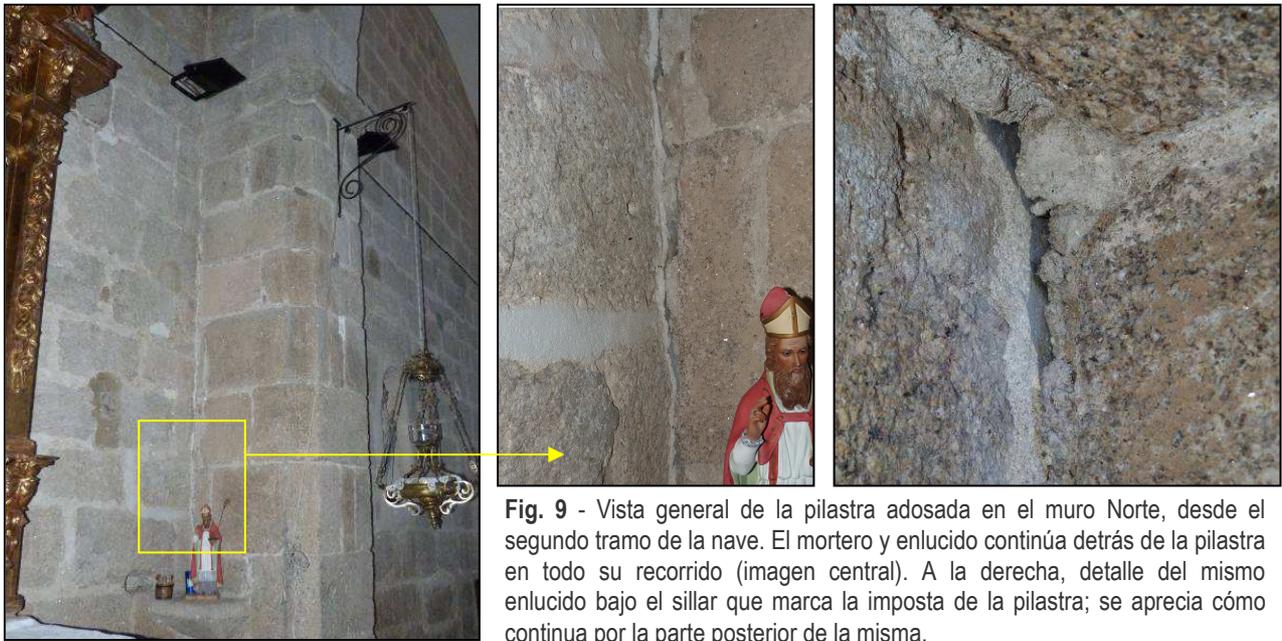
Vista general de la pilastra adosada en el muro Norte, desde el segundo tramo de la nave. El mortero y enlucido continúa detrás de la pilastra en todo su recorrido (imagen central). A la derecha, detalle del mismo enlucido bajo el sillar que marca la imposta de la pilastra; se aprecia cómo continúa por la parte posterior de la misma.
